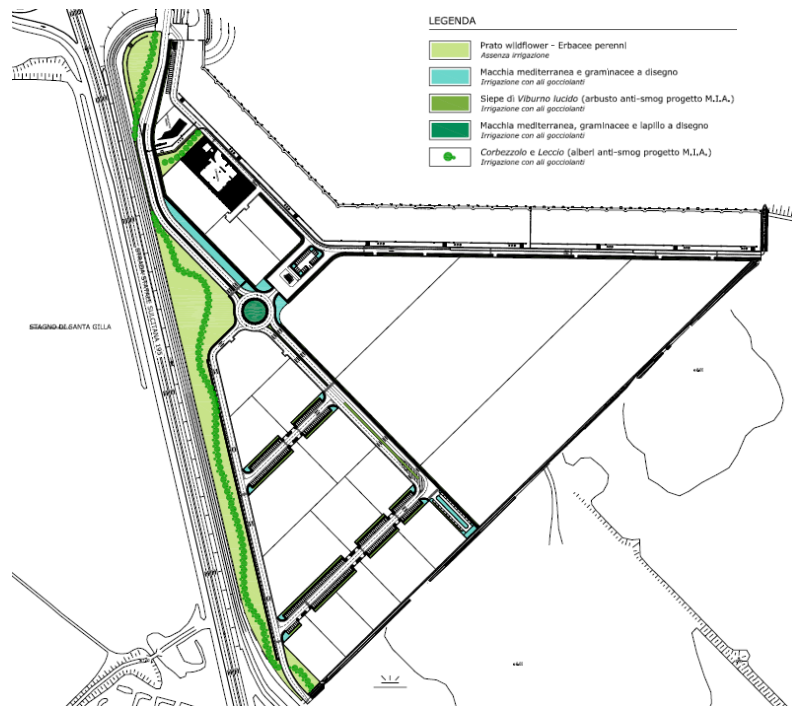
Stralcio progettuale planimetria sistemazione a verde
